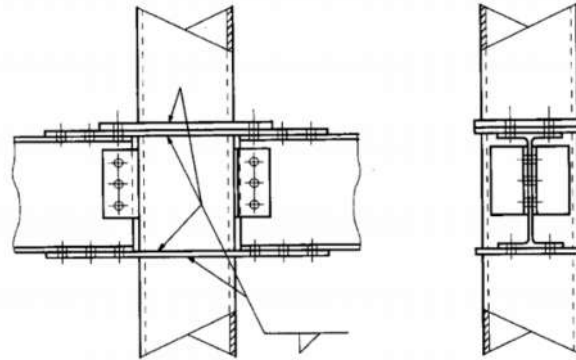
Ligação enrijecida por meio da continuidade da viga através do pilar
